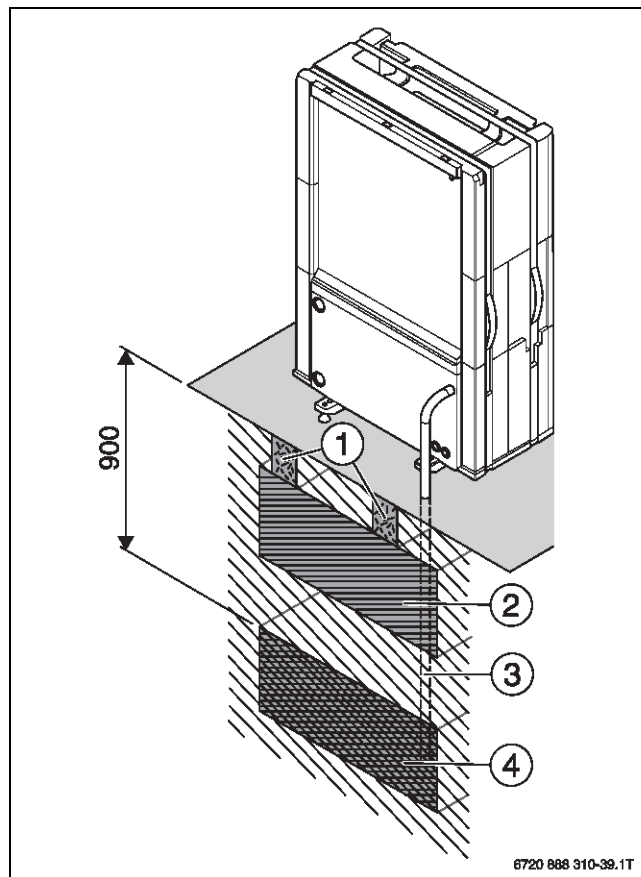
Kondensatablauf in Kiesbett (Maße in mm)
